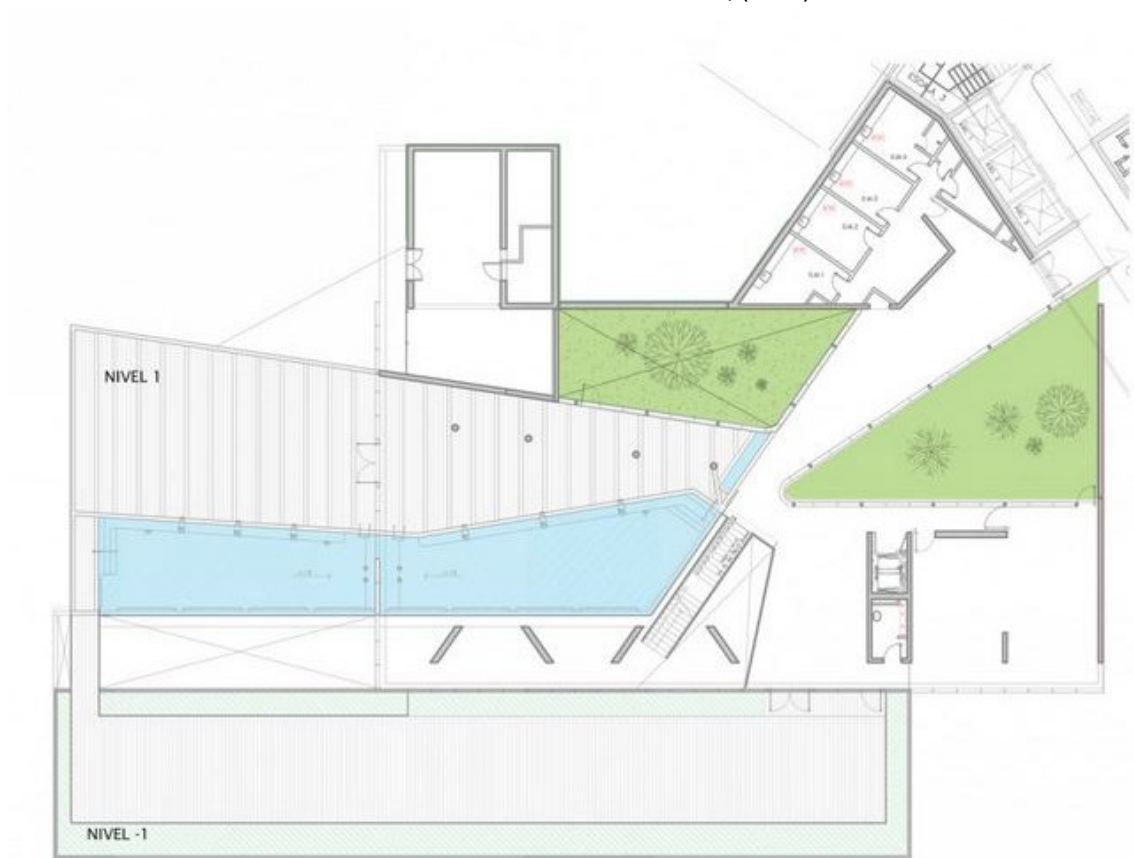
Planta baixa - esquema pátio nível 1.
